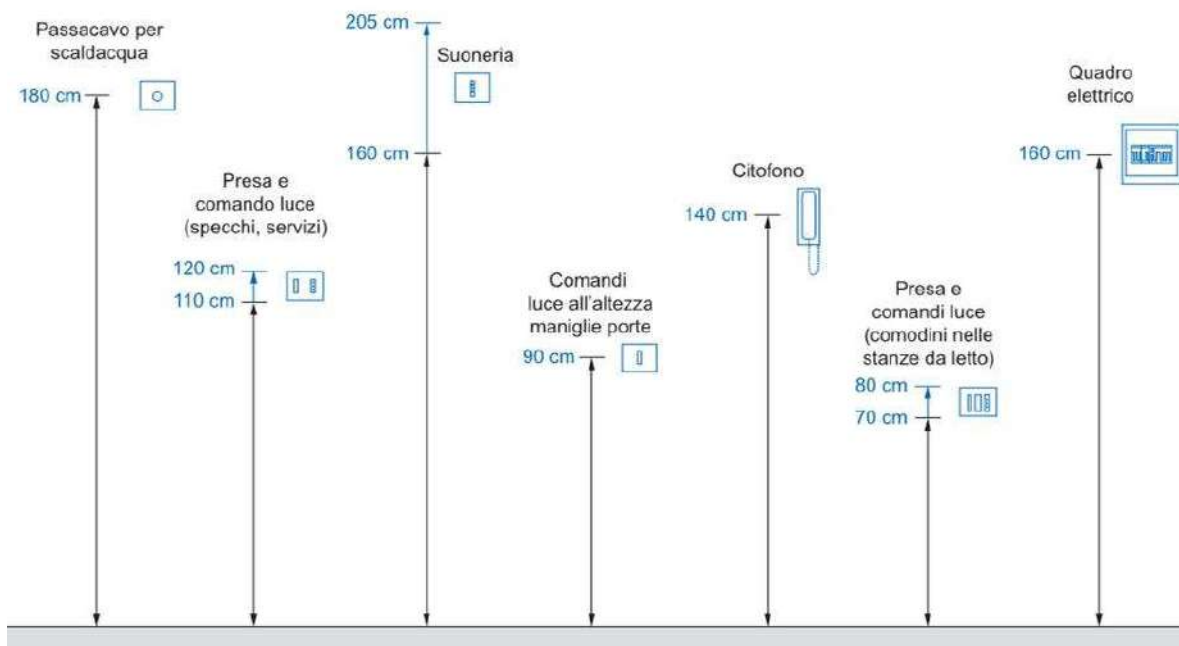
Quote di installazione delle apparecchiature (CEI 64-50).
